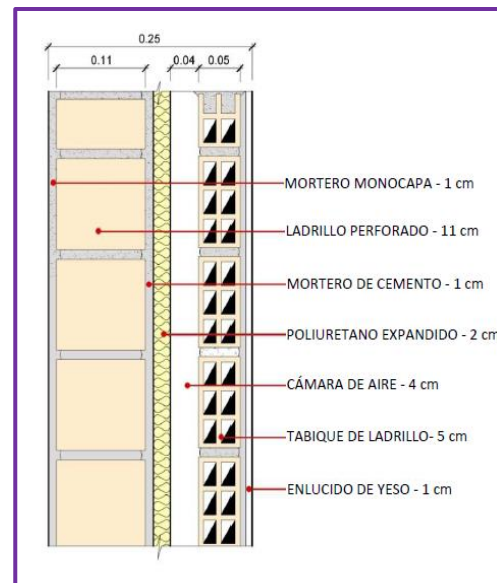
Detalle constructivo de muro revestido
